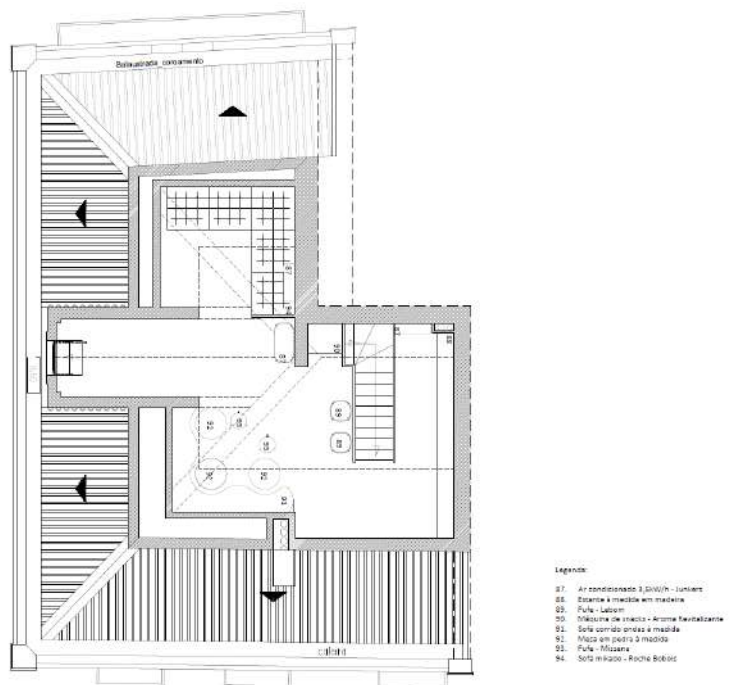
Planta de Mobiliário e Equipamento - Piso das Águas-Furtadas
